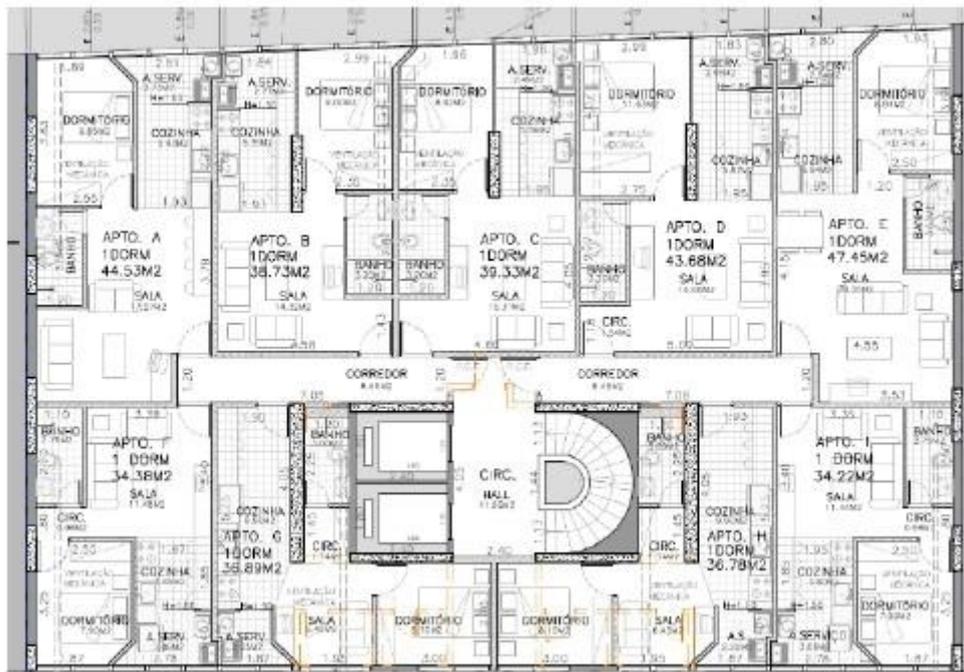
Plantas do Pav. Térreo e Segundo Pavimento
